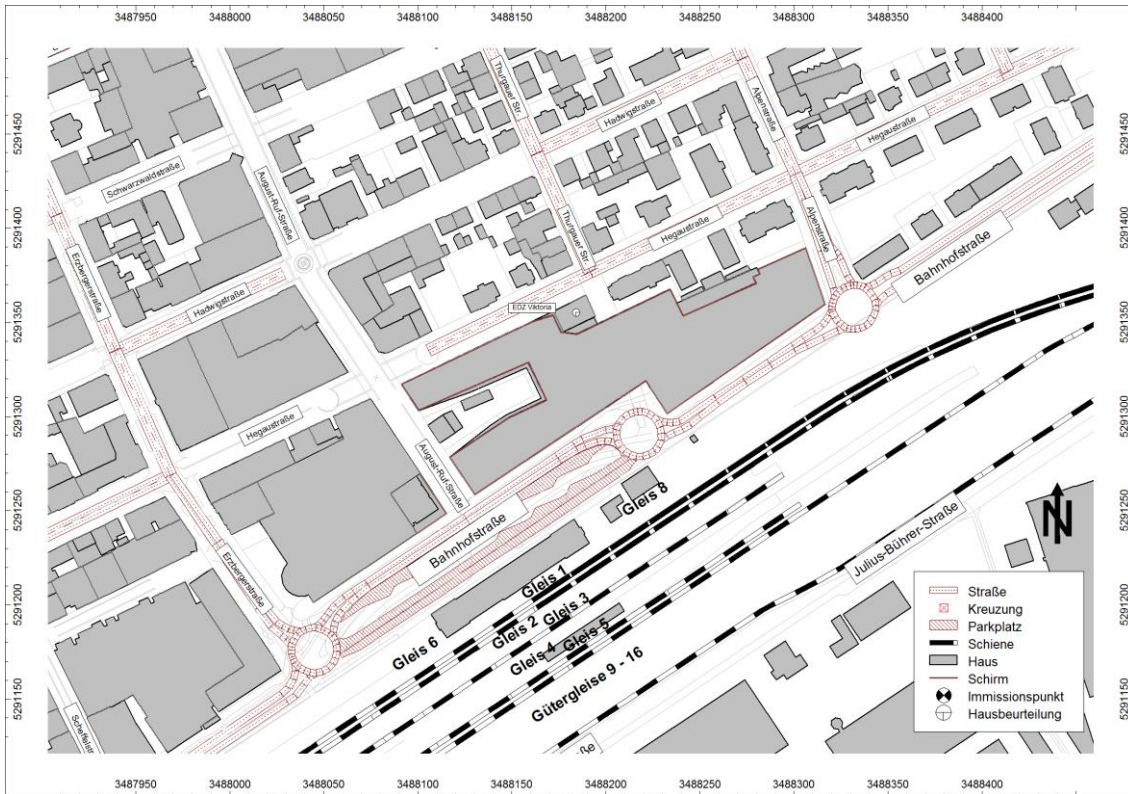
Lageplan Straßenverlauf, Lichtsignalanlagen und Bebauung im Prognose Planfall 2030
